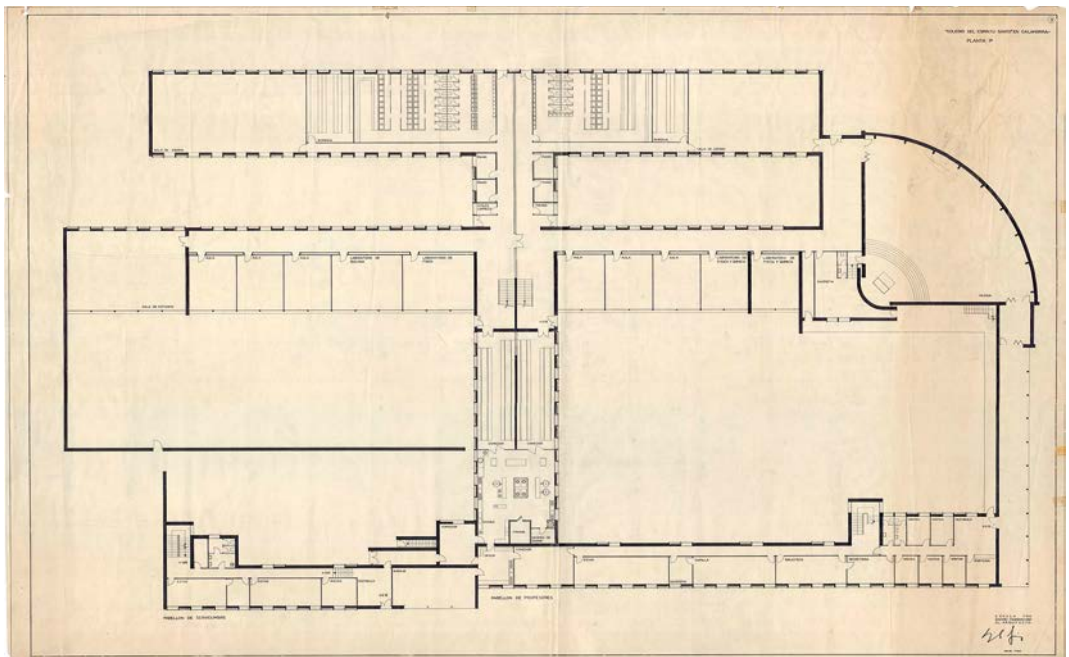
Planta baja. Proyecto. (AFF, sig. 152).
